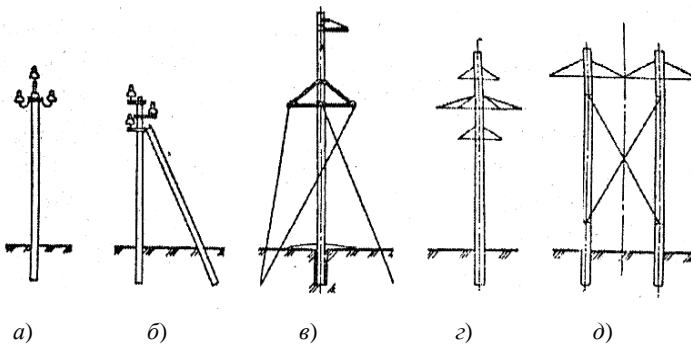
Применение железобетонных опор ВЛ и тип опор:
